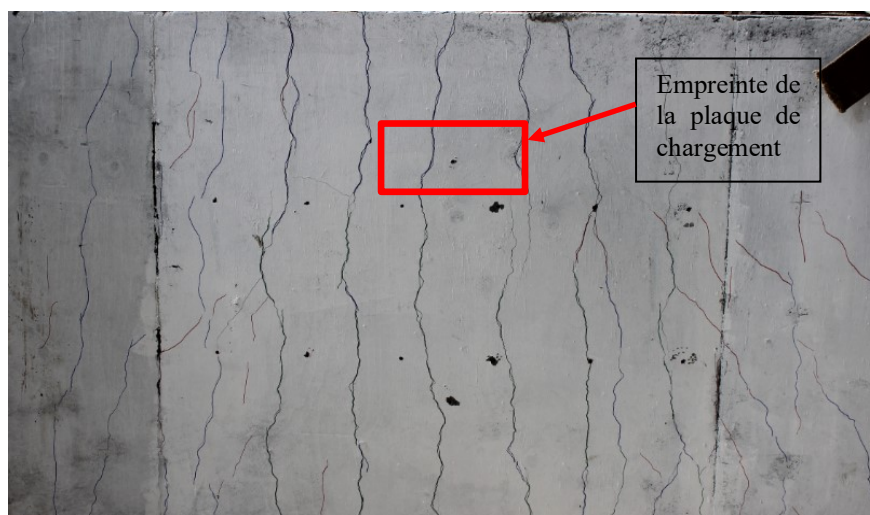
Fissuration sous la dalle en BHP
